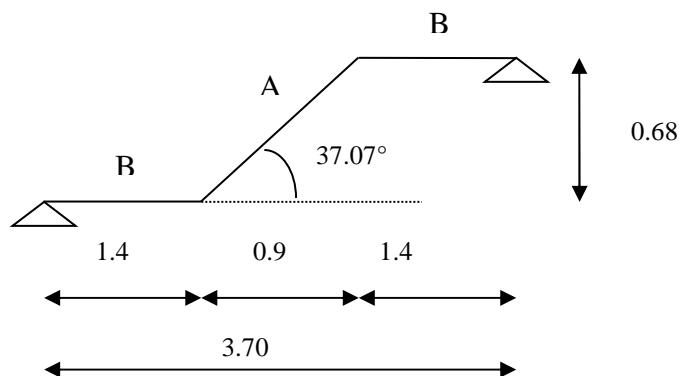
Schéma statique de la poutre palière d'étage courant
